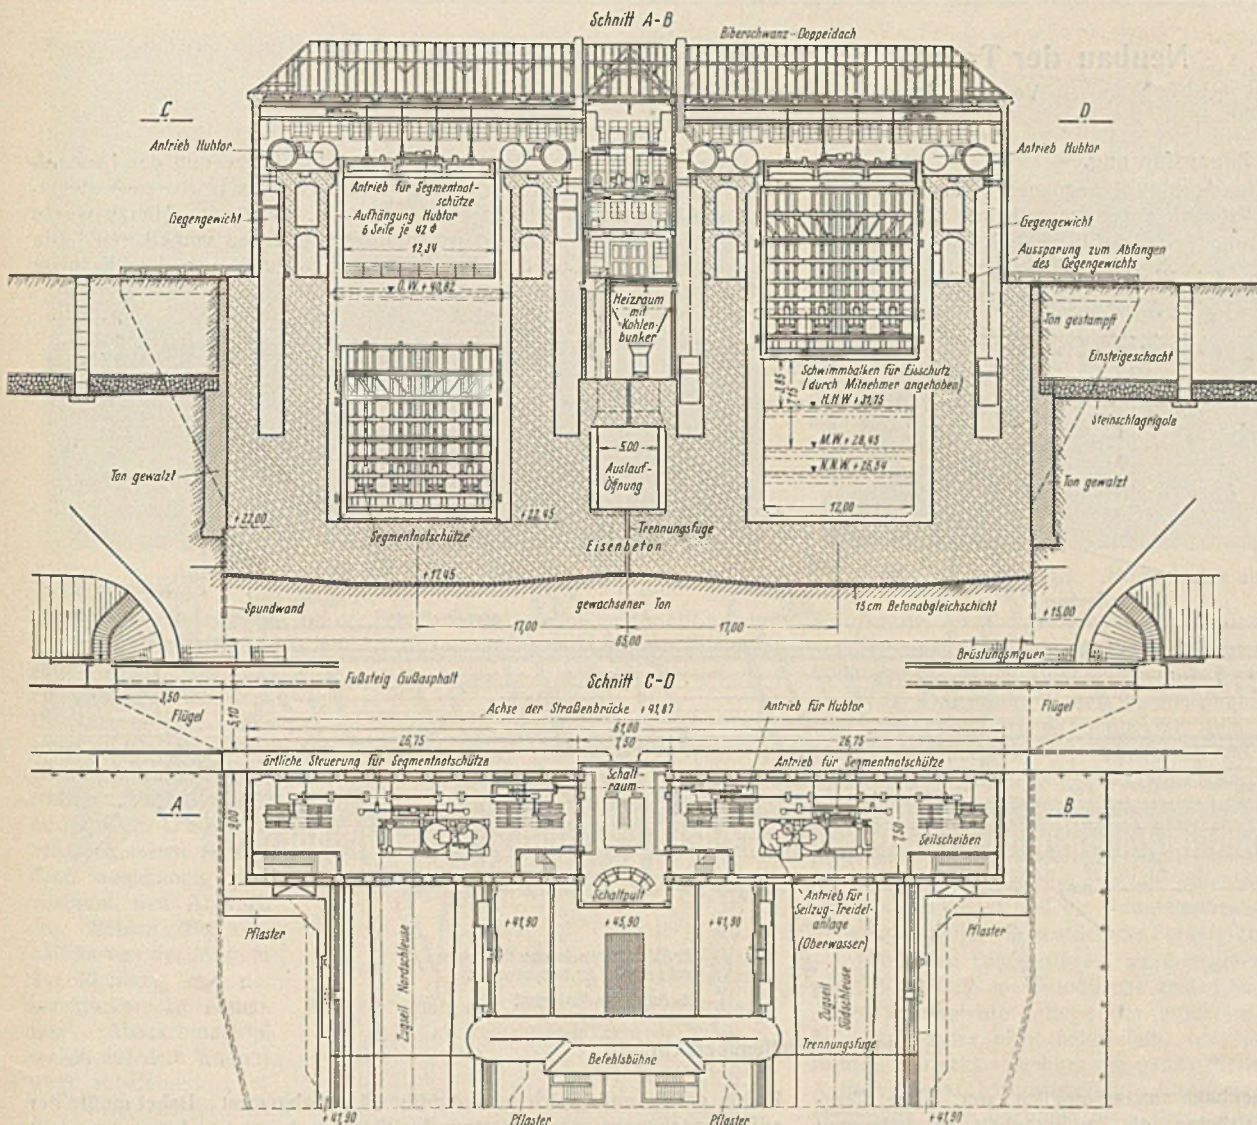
Unterhaupt. Querschnitt und Grundriß.
